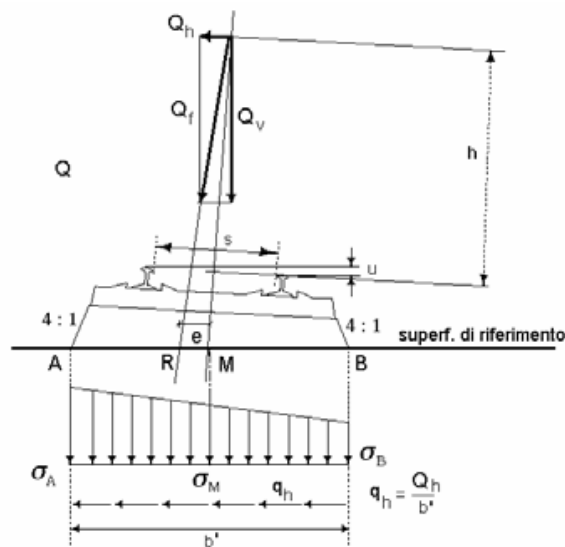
Distribuzione trasversale in curva delle azioni per mezzo delle traverse e del ballast
